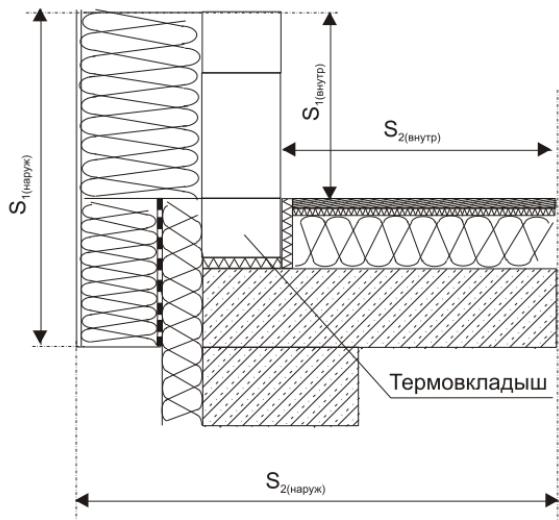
Пример соединения каменной стены с утепленной фундаментной плитой без "теплового мостика"
